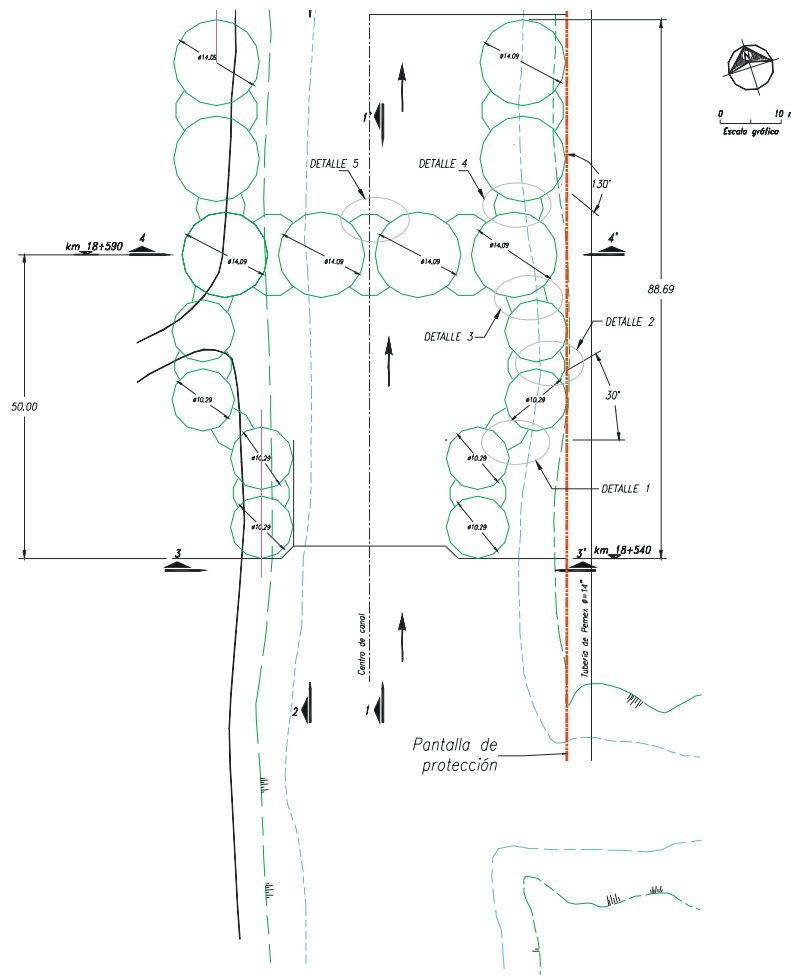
, Estructuras celulares de la Planta de Gran Canal
